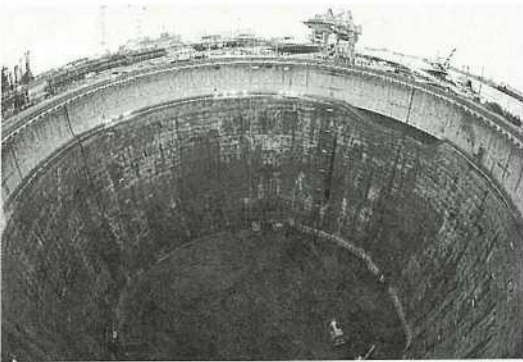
整型 NATM 工法による深さ 57 m, 直径 75 m の床付
